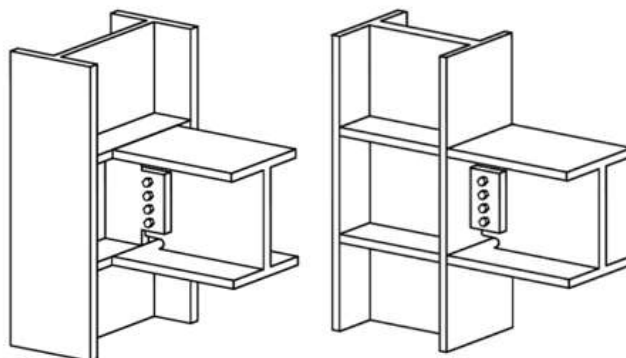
Conexiones tipo WUF-W de viga – columna. Fuente:
